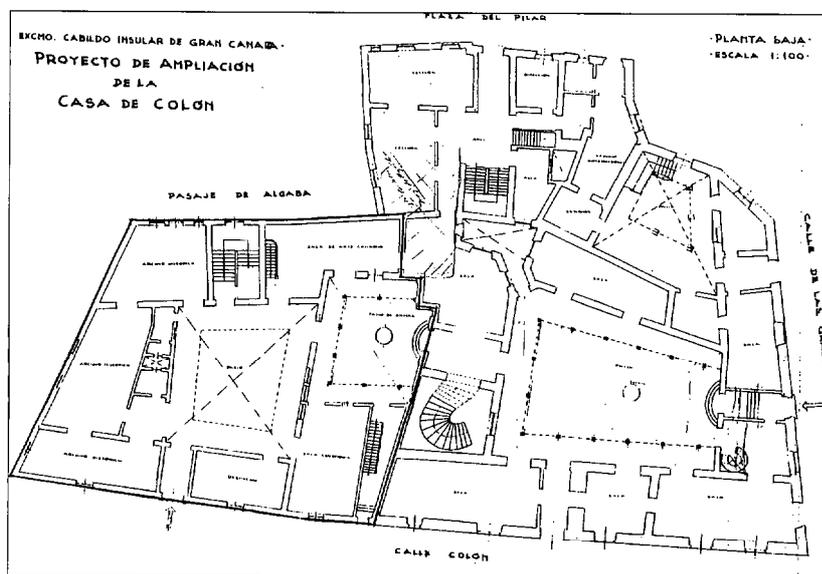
Planta baja. Conjunto de la Casa Colón en su ocupación actual.
